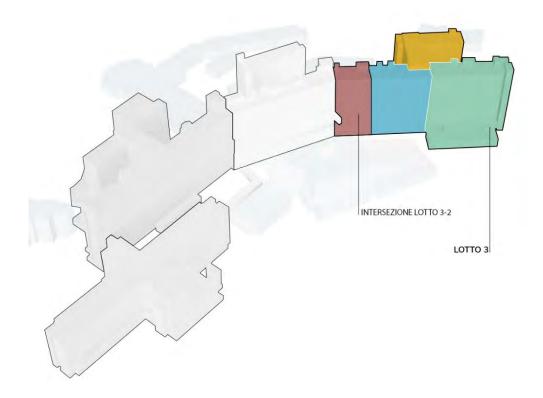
FASI DI RISTRUTTURAZIONE - LOTTO 3
